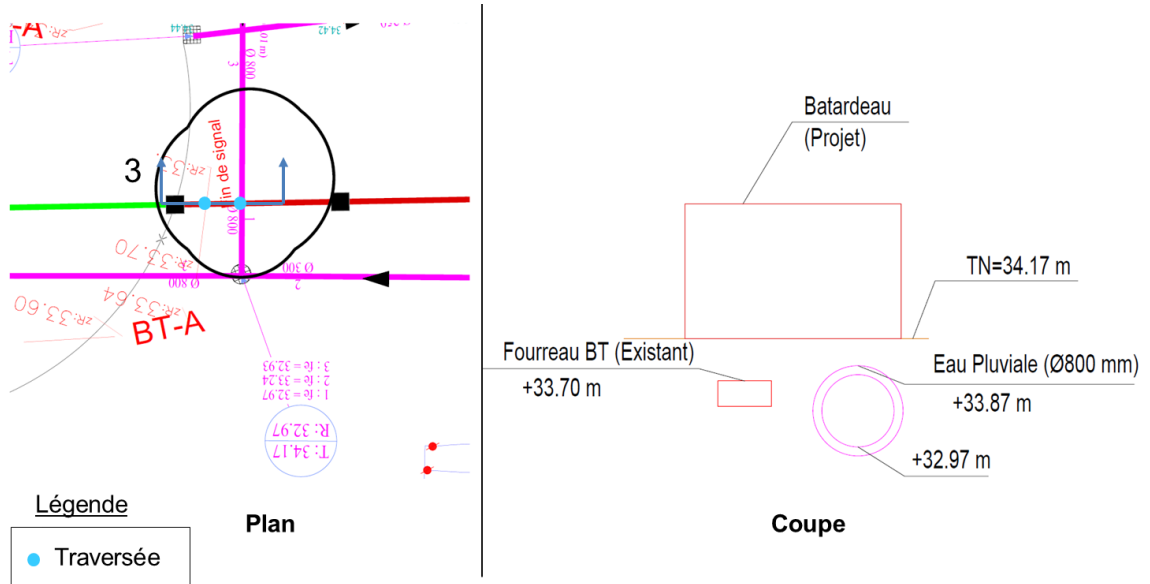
Batardeau traversant un fourreau basse tension et une conduite EP
